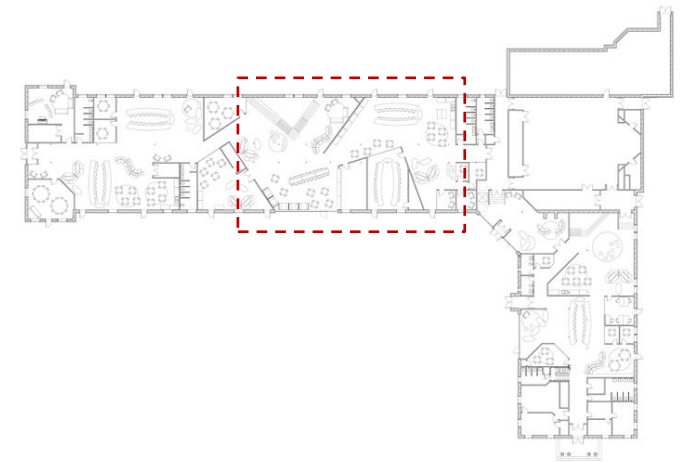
Planta-baixa do segundo pavimento e parte da cobertura
